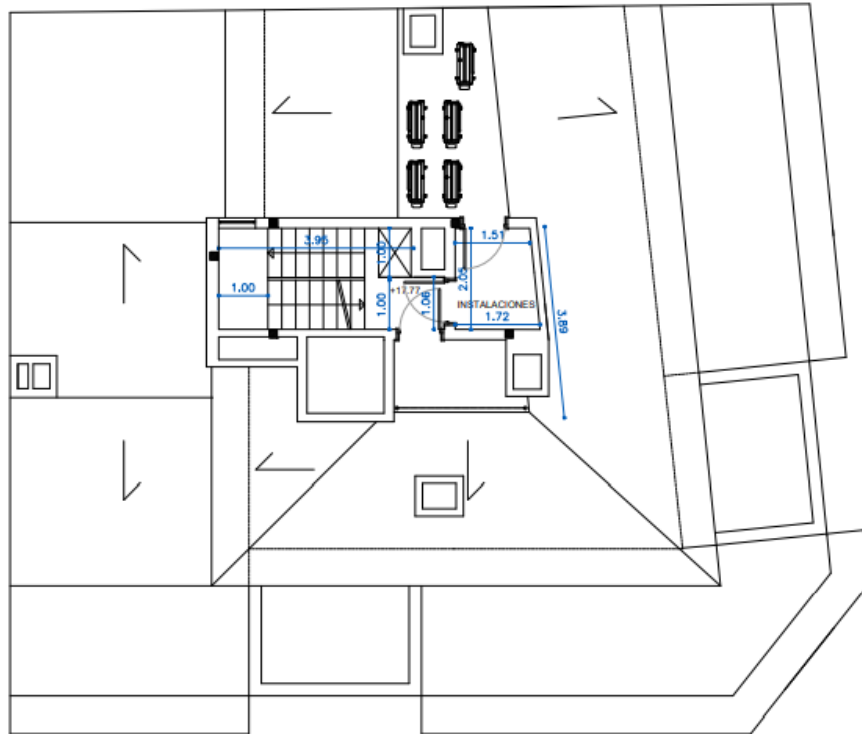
Imagen del plano de la planta ático. (Fuente: GREEN SOLID S.L)
